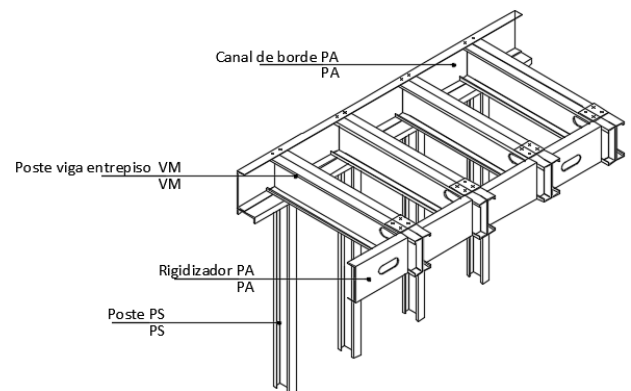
, Cubierta para entrepiso. (Fuente: propia del autor.)
